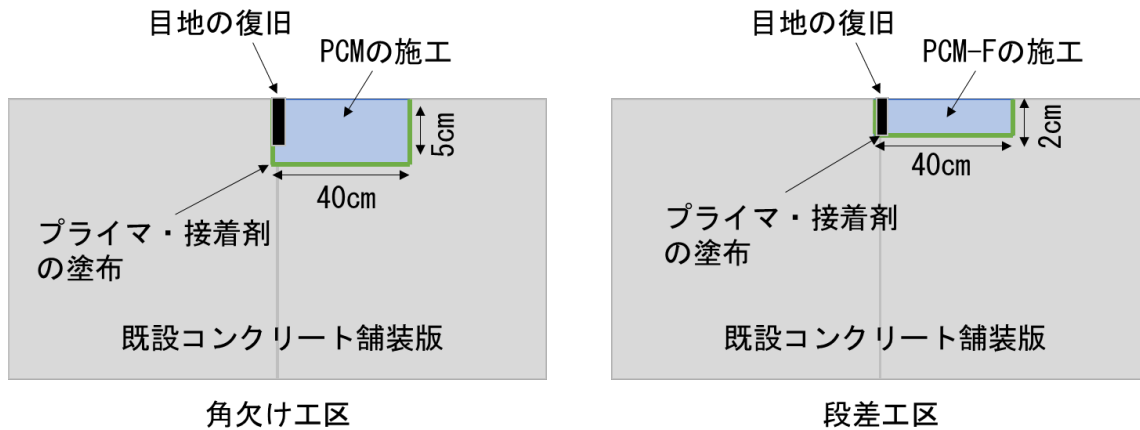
小規模補修技術の施工断面（左：角欠け，右：段差）
